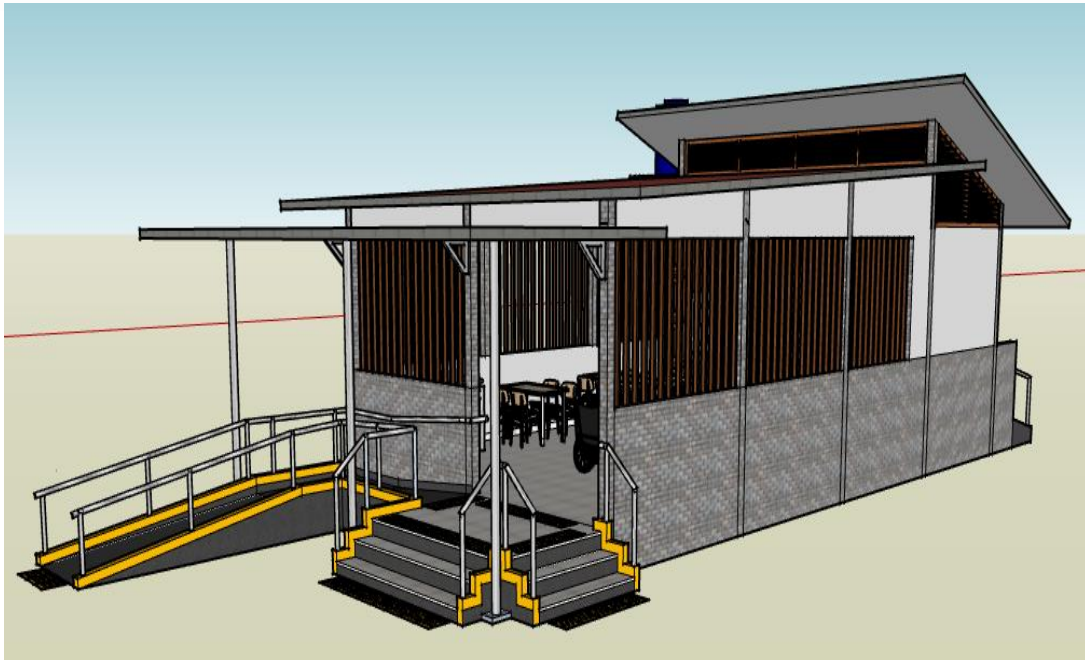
Ilustrasi Eksterior Bangunan Kantin Tipe A
